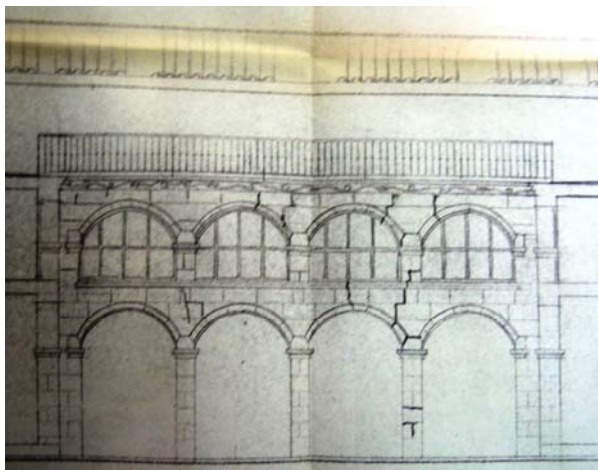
Convento de San Antonio. Alzado del claustro. Estado previo. AGA, IDD (3)115 caja26/1637.
